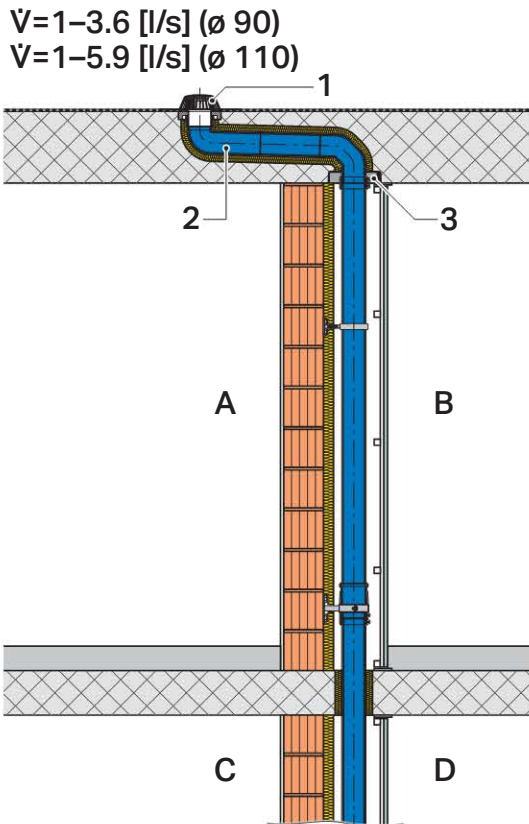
Ansicht Fallstrang mit eingelegter Anschlussleitung
